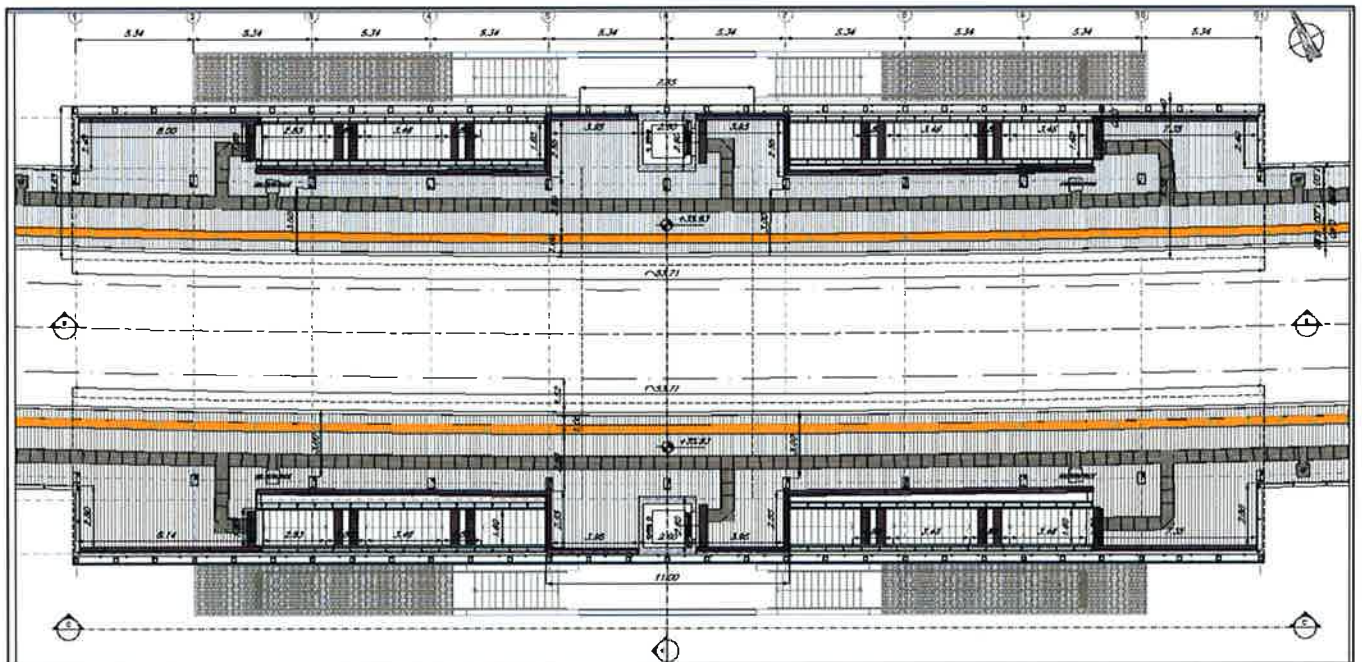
Pianta quota banchina Fermata Centro Commerciale
